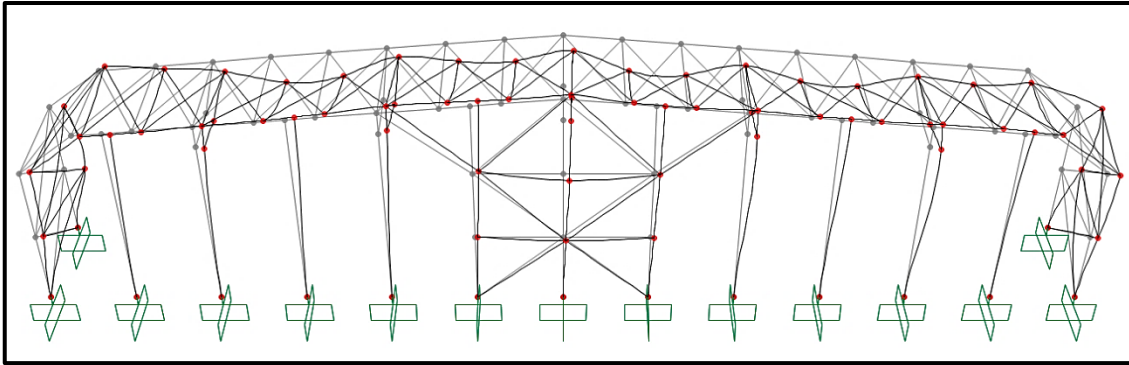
Deformada muro hastial. Estructura arriostrada.
